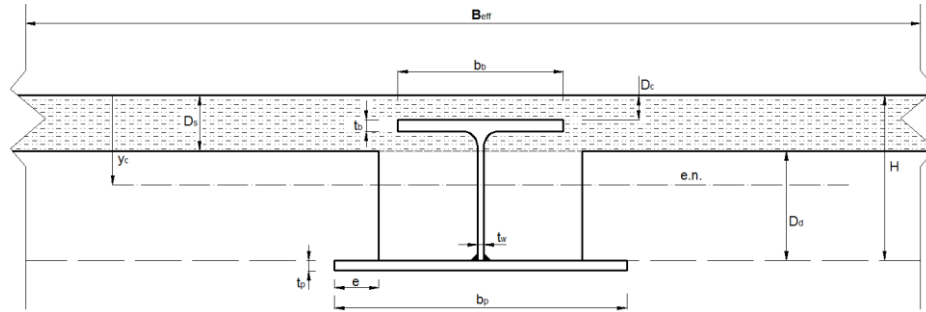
Secção de uma viga mista do tipo *Integrated Floor Beam*.
